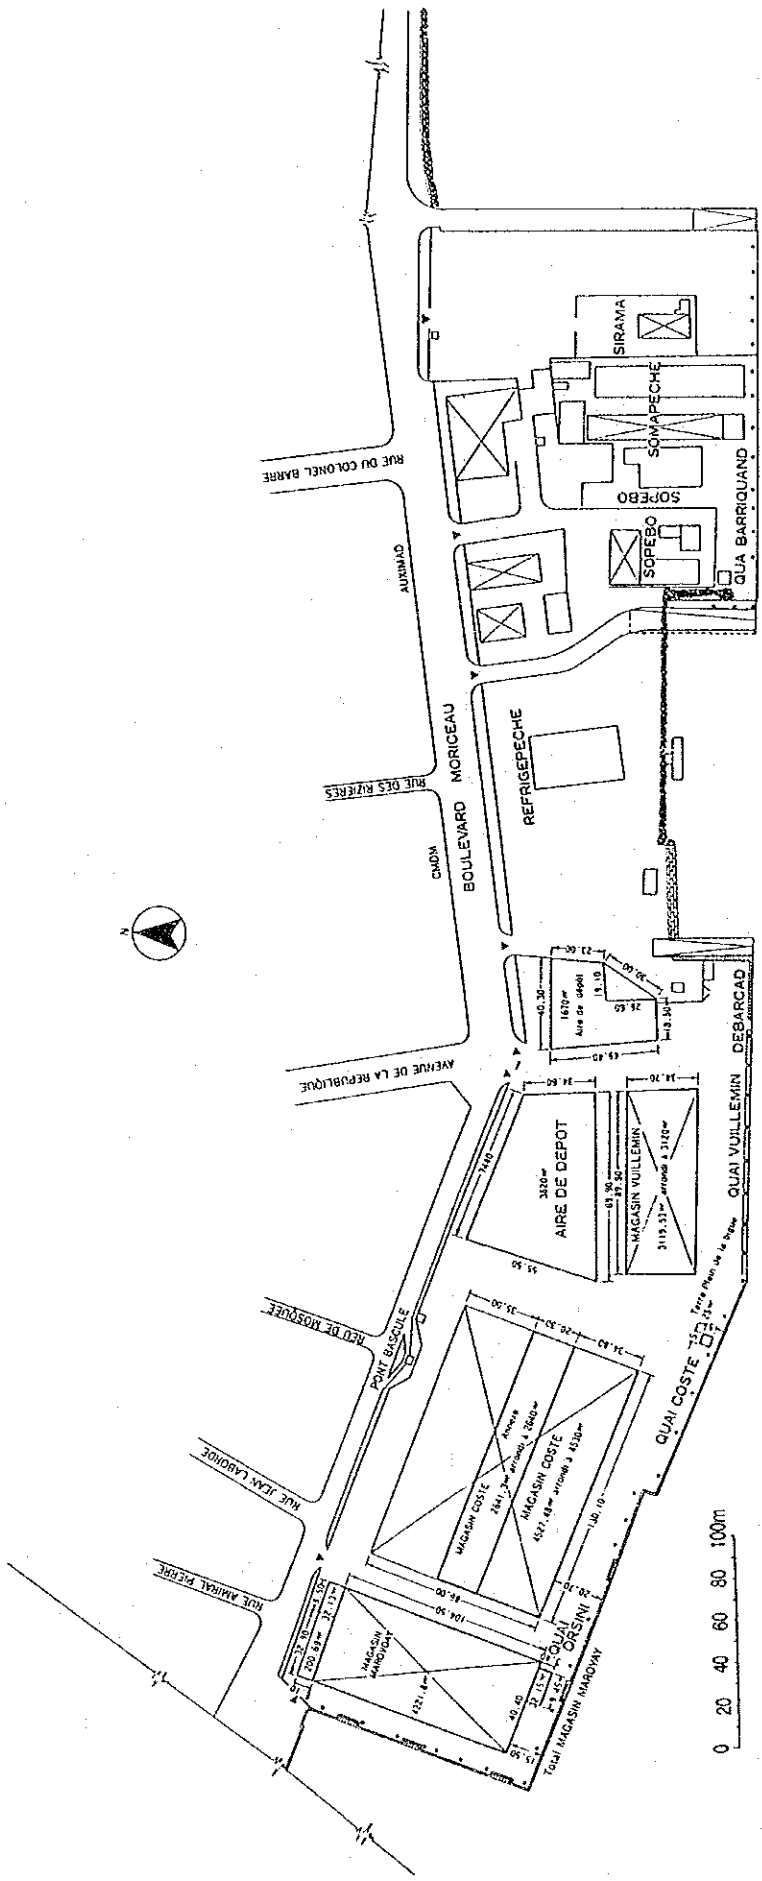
Plan d'implantation du Port de MAHAJANGA
